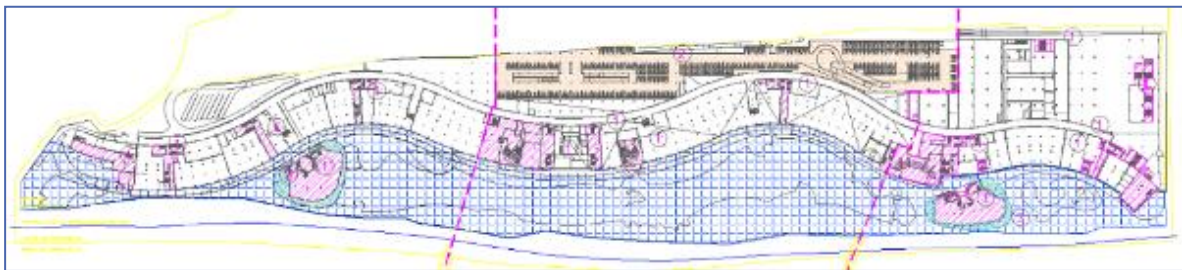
En este corte se muestran en color rosa, beige, azul y verde las áreas proyectadas para este nivel
